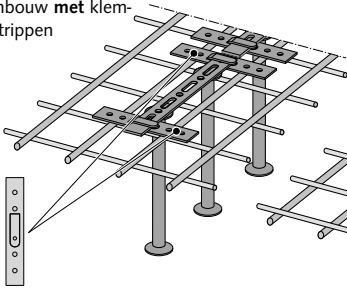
De ponswapeningselementen worden van boven door de reeds aanwezige bovenwapening gestoken
